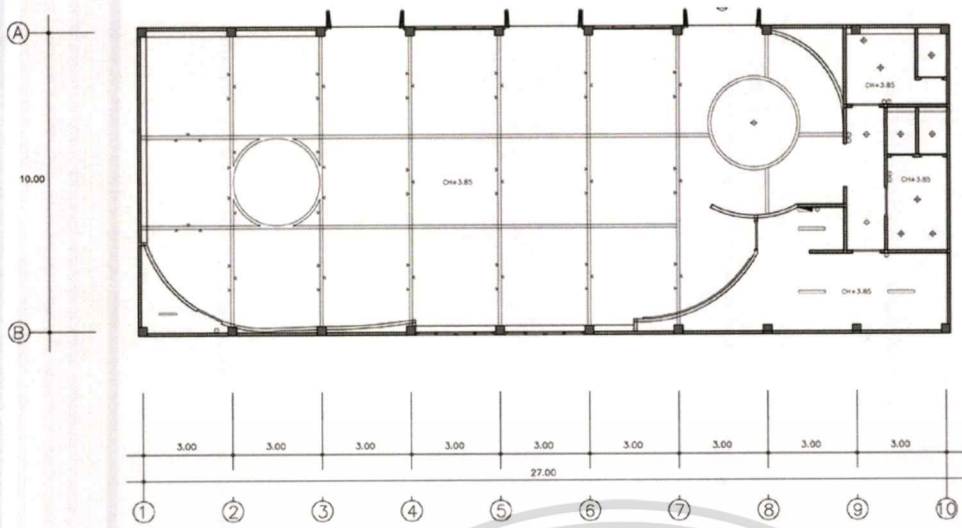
ภาพแสดงผังเพดานและไฟฟ้าของ Building D ชั้น1
